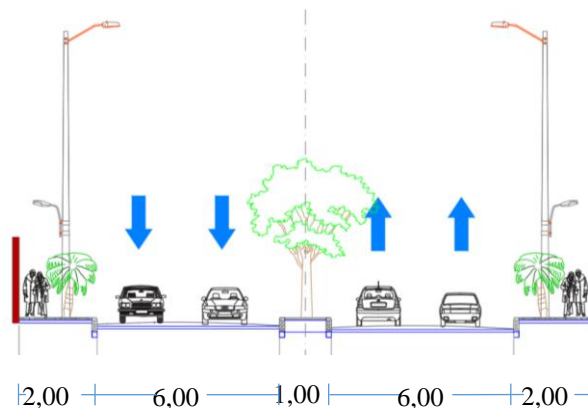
Perfil vial de la calle 45. Adaptado de (*Planeacion, Plan de ordenamiento territorial de Bucaramanga, 2014*)
